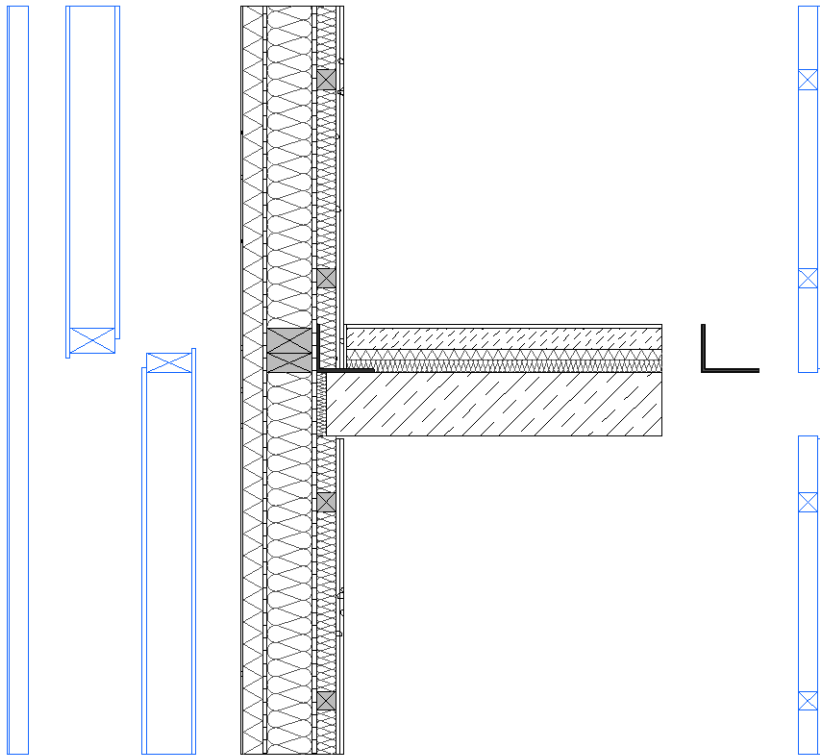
Montagefolge eines Geschossstoßes mit vorgestelltem Fassadenelement und Installationsebene (entnommen aus [18])
